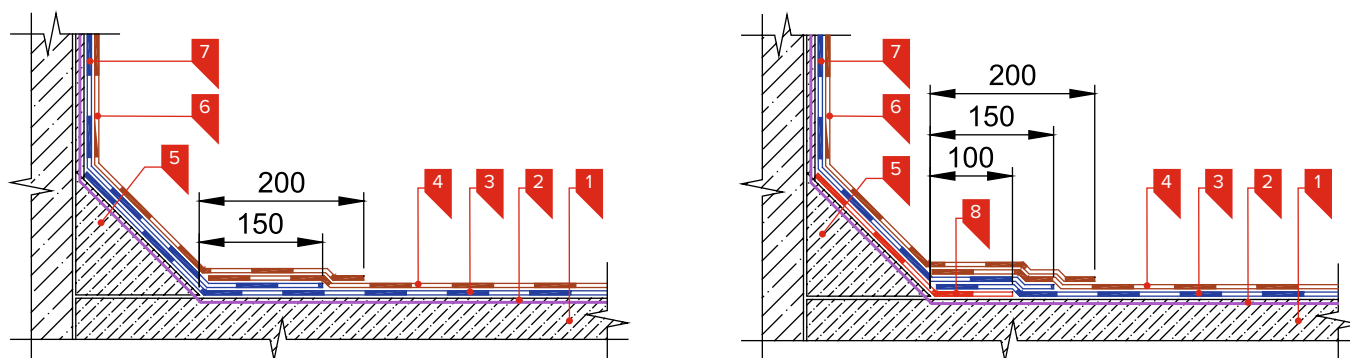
Варианты раскладки водоизоляционного материала на переходном бортике при двухслойном водоизоляционном ковре.
